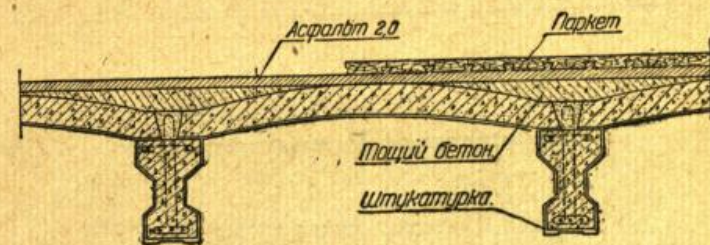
Сборное перекрытие из железобетонных балок и бетонных сводиков.
